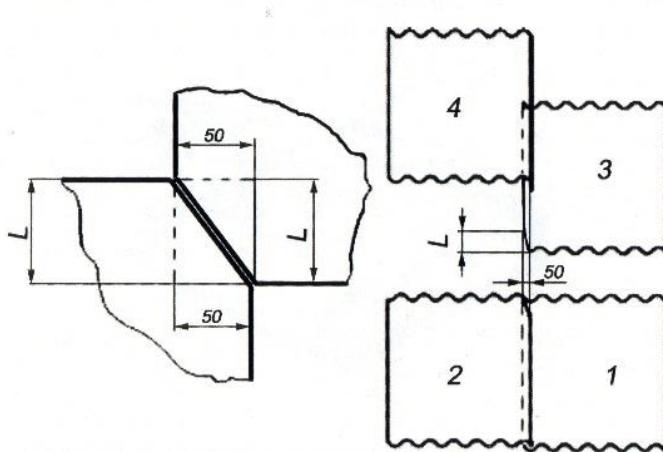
Схема обрезки углов перекрываемой и перекрывающей кромок листов СЕ:
